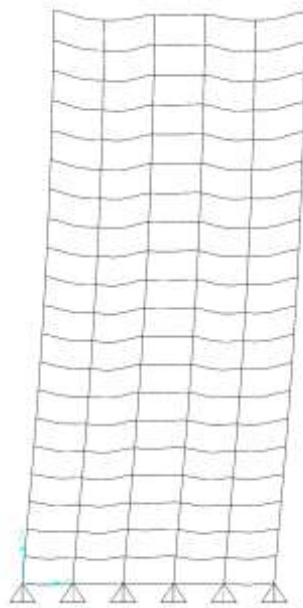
Deformadas – Corte Transversal passando pela Viga V12 – Caso 1 – Com o vento
